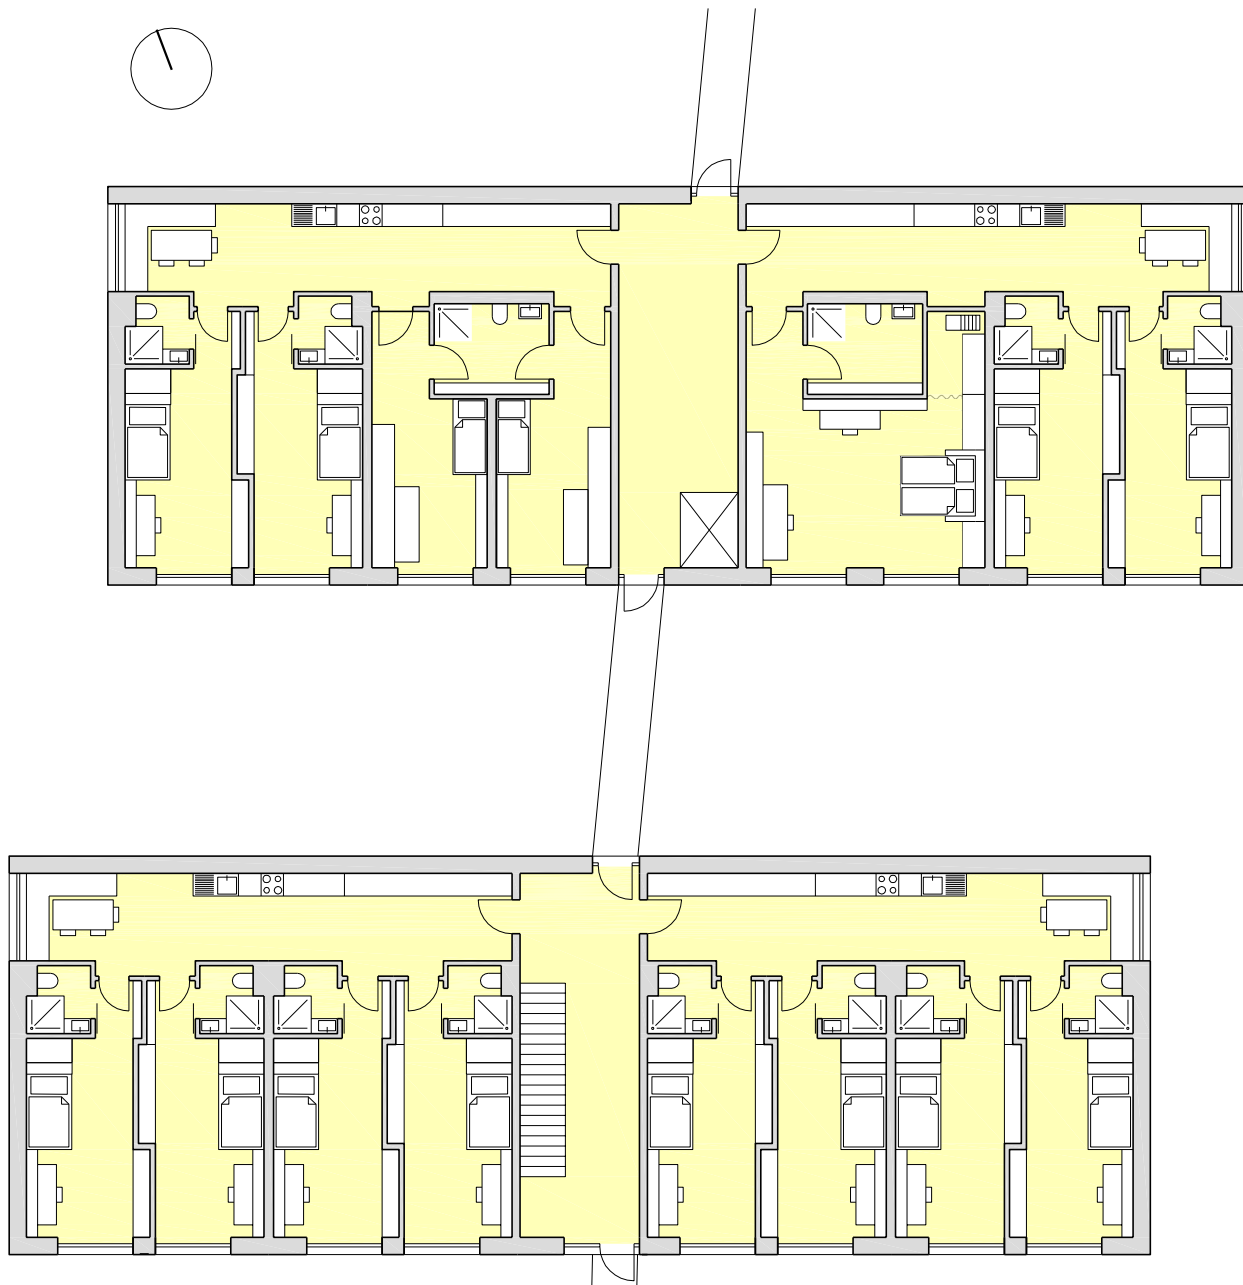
Grundriss - 1. Obergeschoß M 1:200
